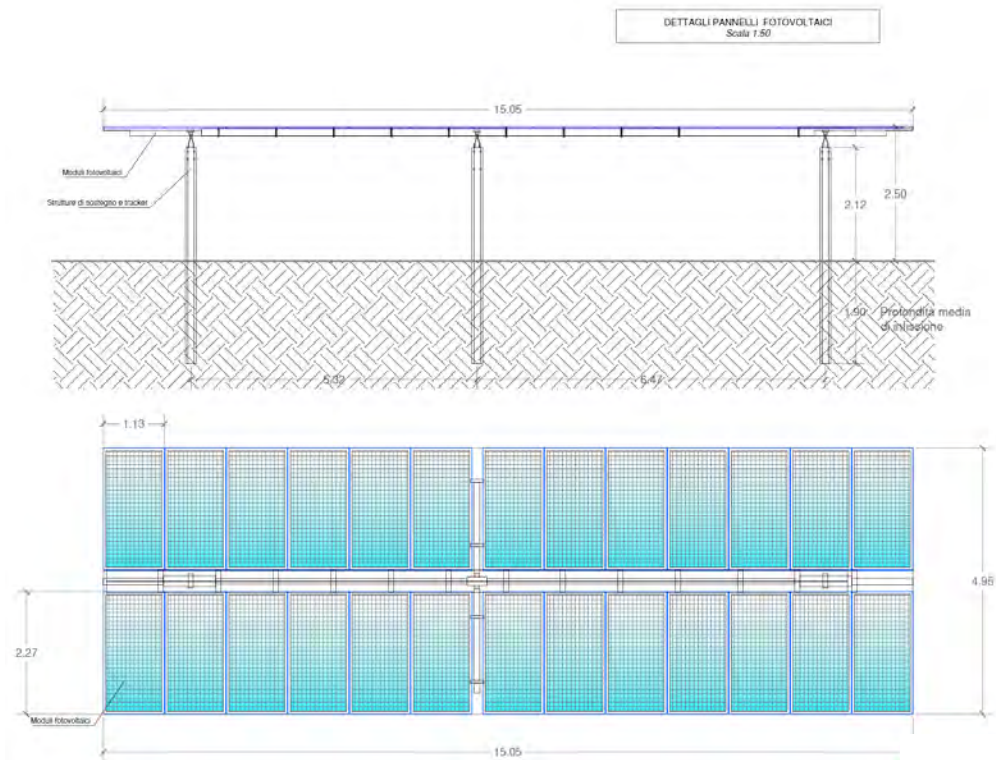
Particolari e dimensioni di una stringa da 26 pannelli
